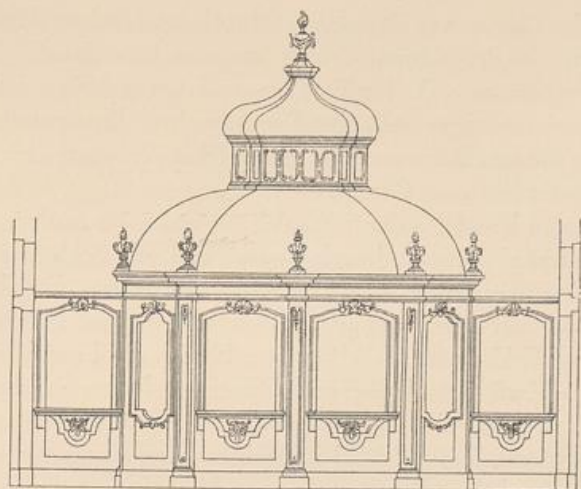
Entwurf für einen Gartenpavillon von J. J. Couven. Vgl. dazu Grundriß Abb. 104.
